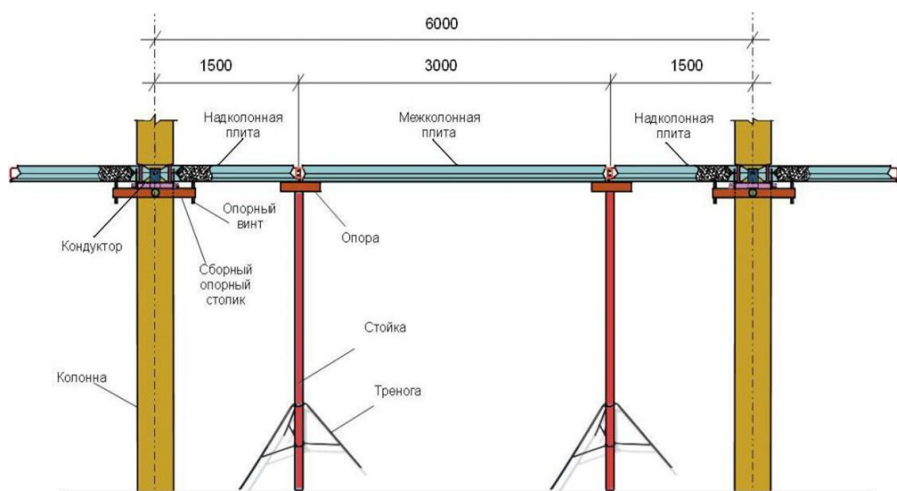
Пример мелкой инновации – конструктивное усовершенствование системы монтажа безригельного каркаса
